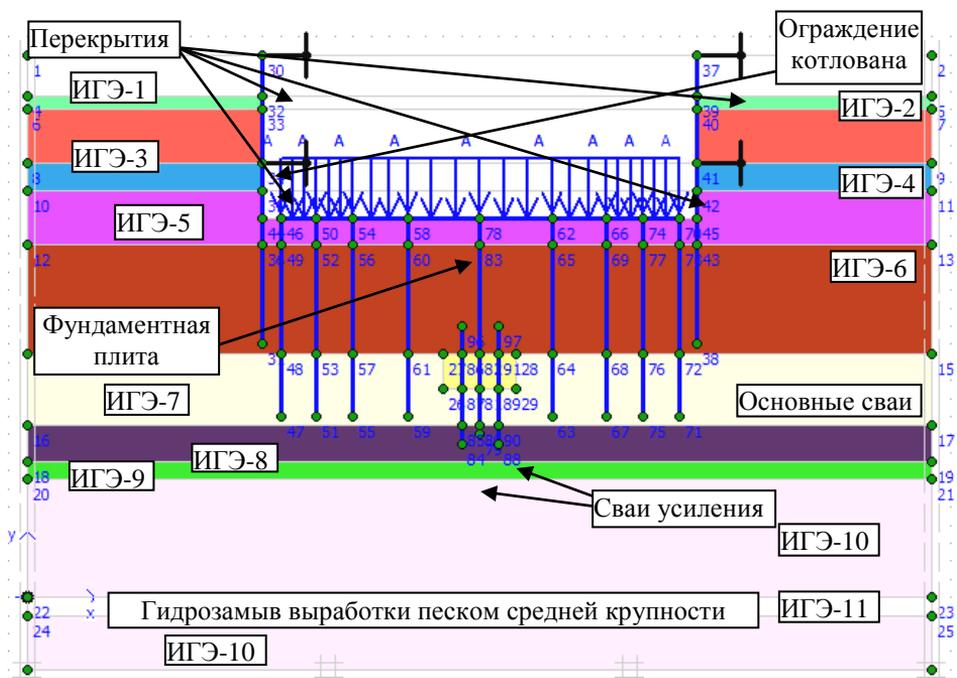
Расчетная схема (сечение 2–2) для моделирования НДС системы «З – СПФ – ОПВ» в плоской постановке
